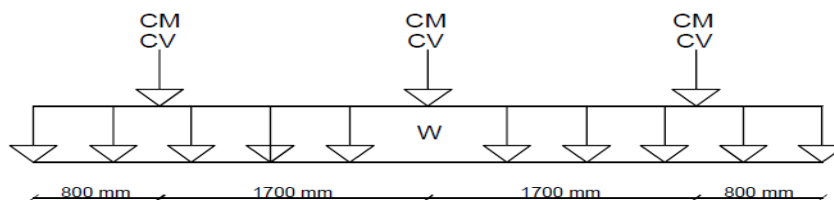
Carga que actúan sobre la viga de asentamiento. Elaborado por: Autor
